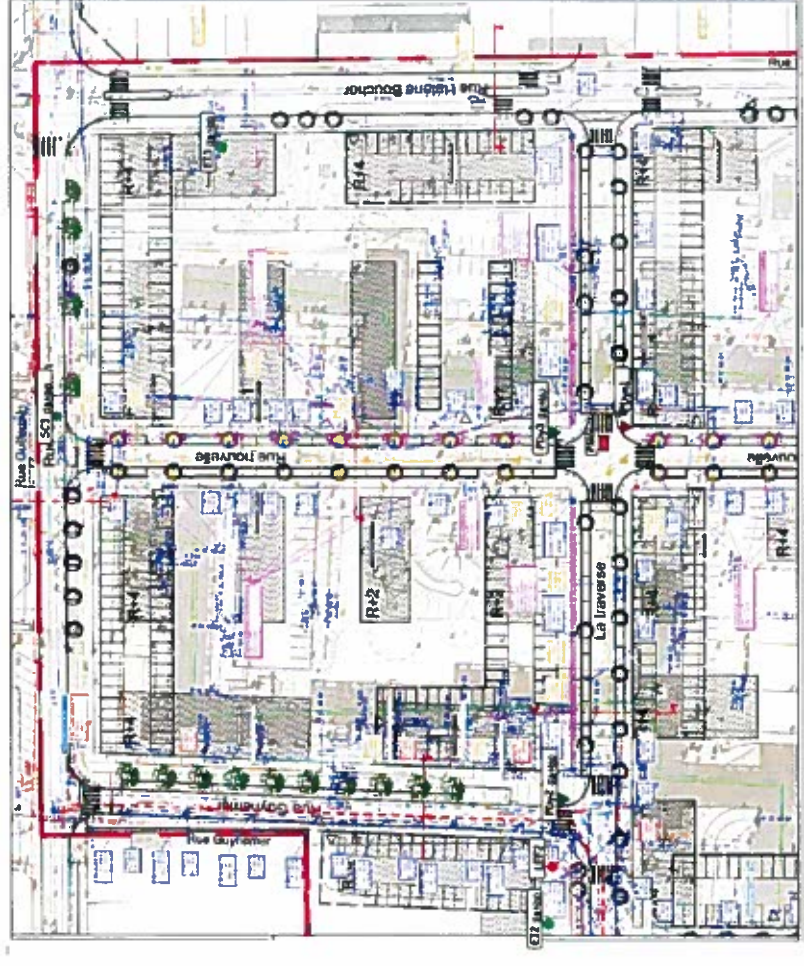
Plan d'implantation des sondages de l'étude FONDASOL d'avril 2017 - secteur Nord
